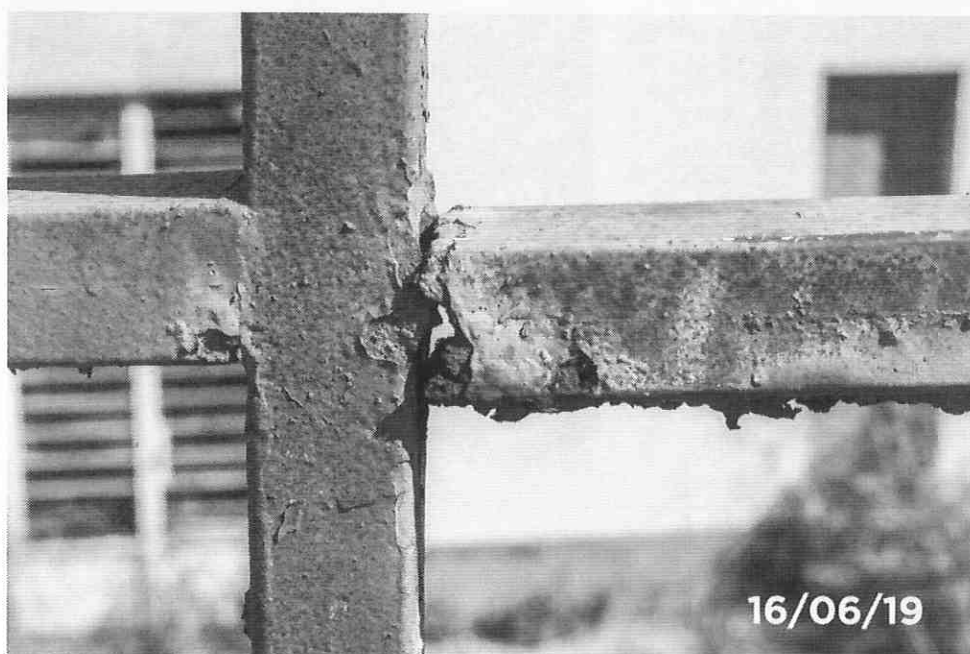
Detalhe pontos de corrosão na estrutura metálica no guarda corpo.
